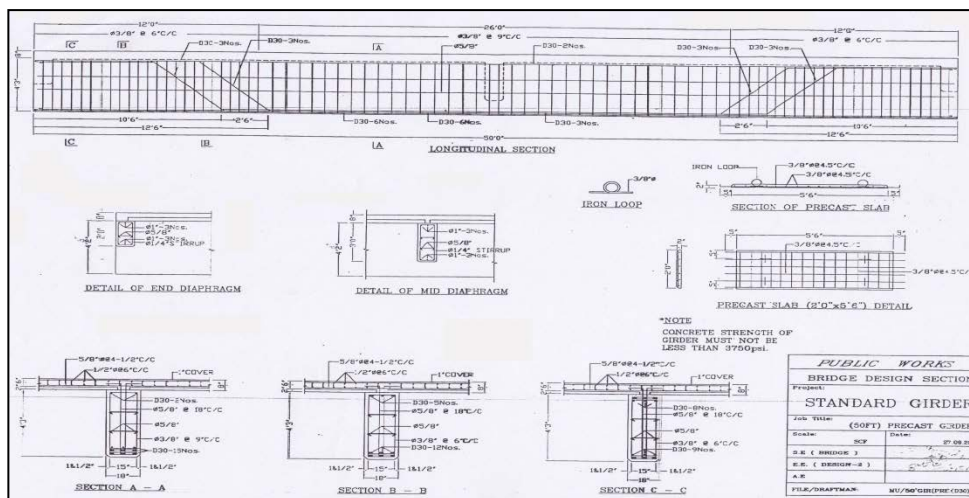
コンクリート桁橋の床板（Type I）の一般図
